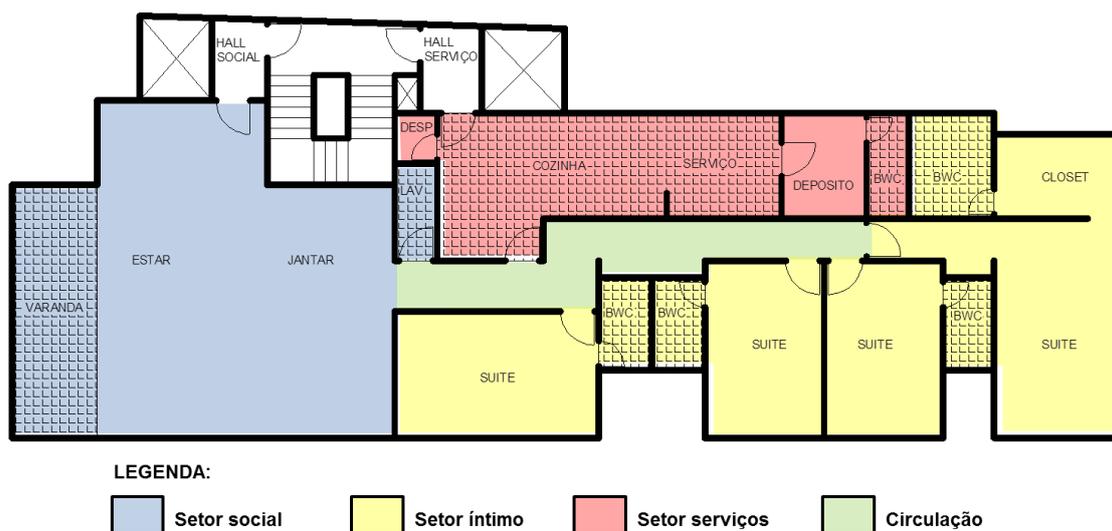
Planta esquemática de apartamento localizado na Avenida Boa Viagem, projetado em 2001.
